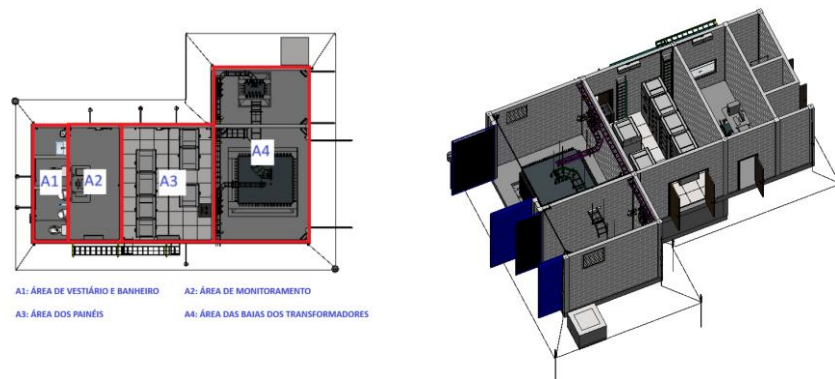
Planta baixa e modelagem tridimensional do ambiente projetado.
